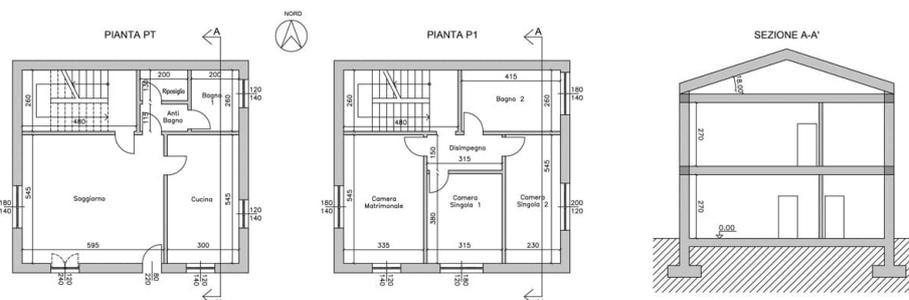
Planimetrie Piano Terra e Primo Piano, Sezione A-A'.
